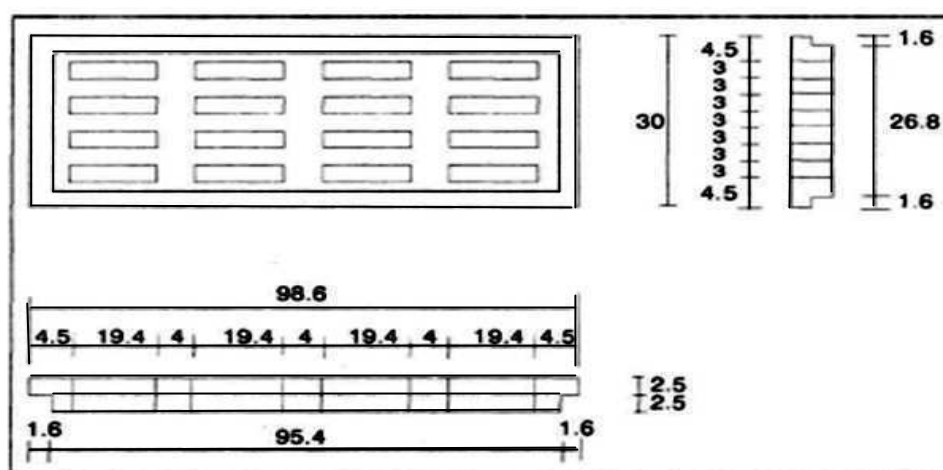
Reja horizontal para tragantes (todas las medidas están en centímetros)
